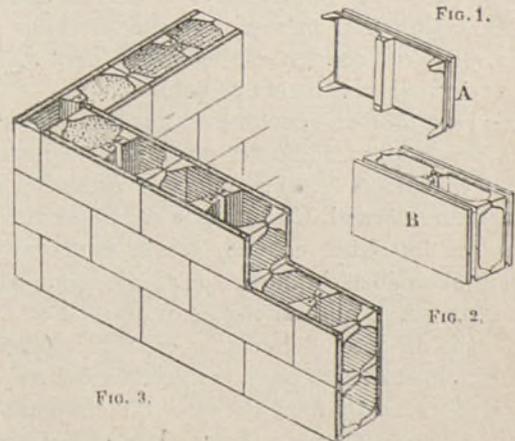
a 3.—Elementos «doble C» y detalle de un muro construido con elementos de este género.
